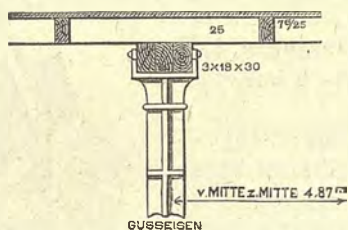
Struttura dei solai di un magazzino in Paddington a Londra.
